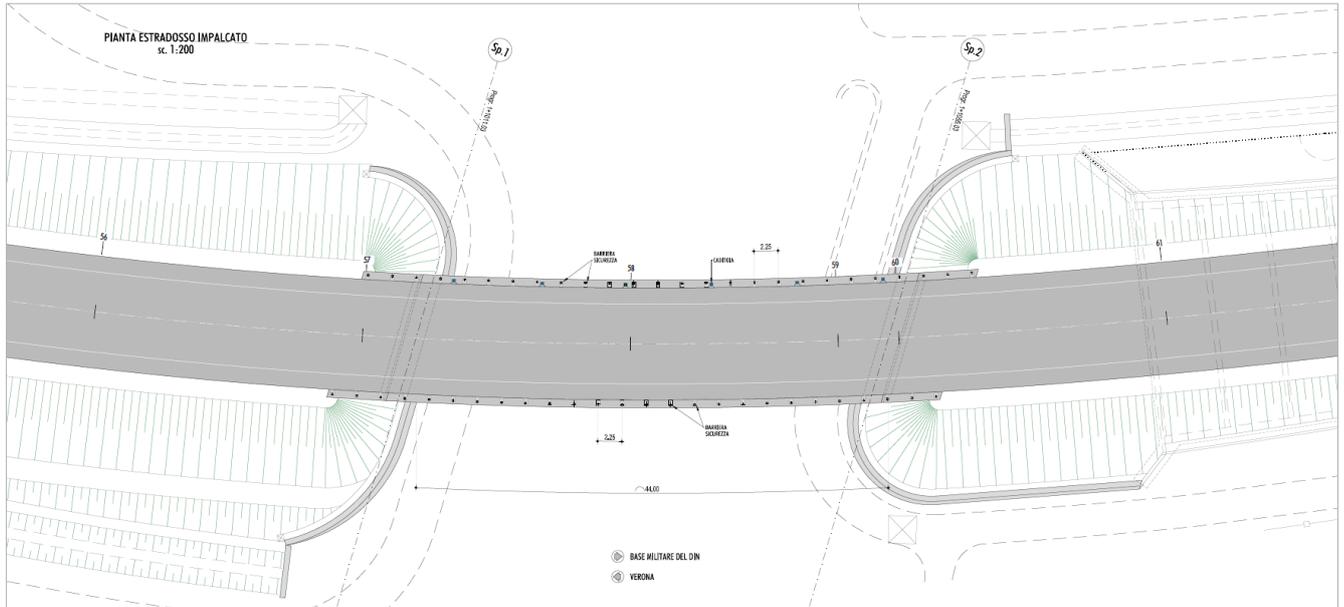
VISTA IN PIANTA DEL PONTE – LIVELLO IMPALCATO
